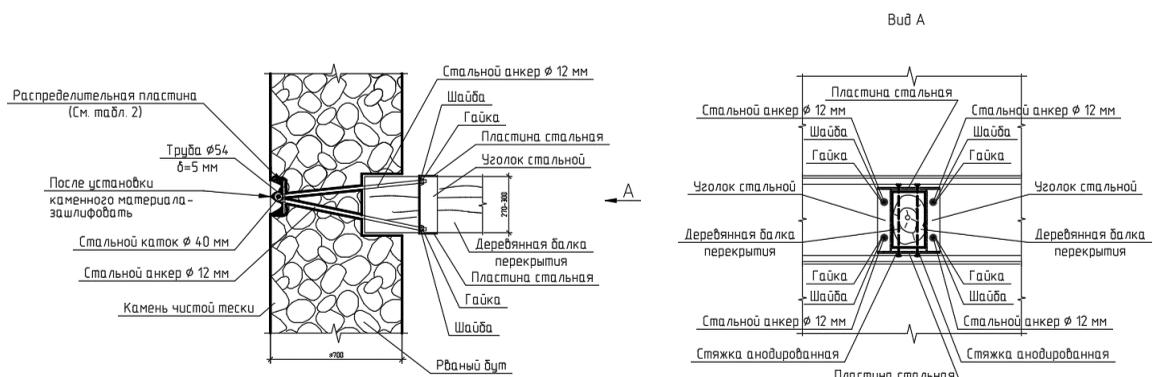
Схема закрепления деревянных балок перекрытия с каменными стенами
